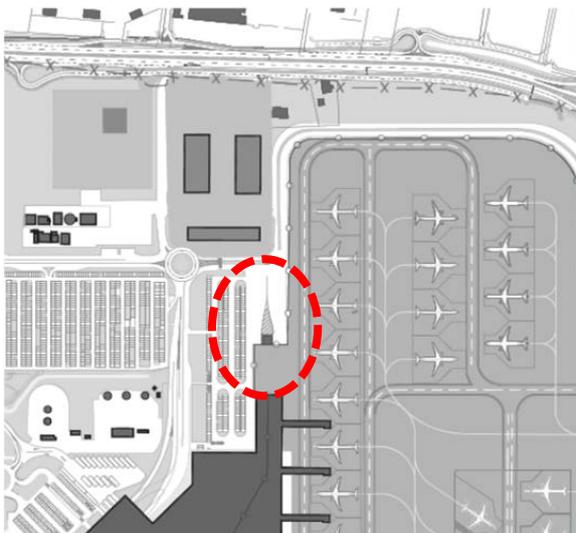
DHL nuovo cargo building (codice 2.33) - Studio di progetto, planimetria generale.
